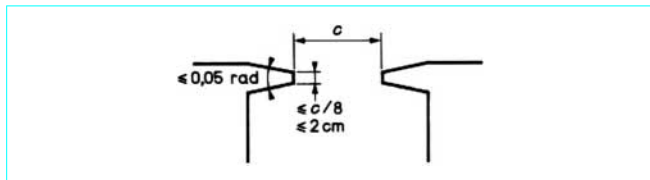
Noyau d'une articulation à section rétrécie (détail)
